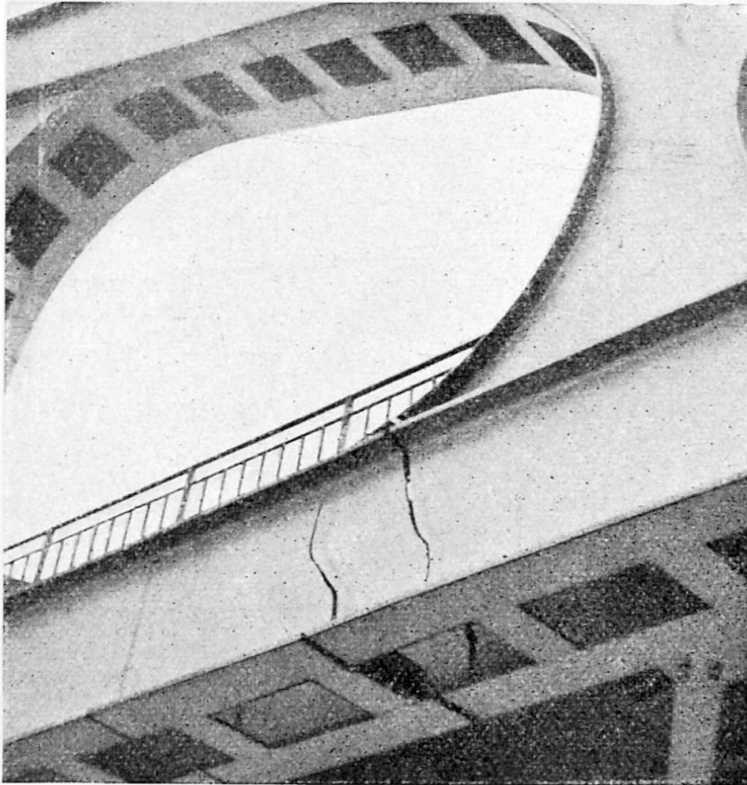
Fissures produites dans la maîtresse-poutre, du type Vierendeel, du pont de Hermalle au-dessus du canal Albert.
